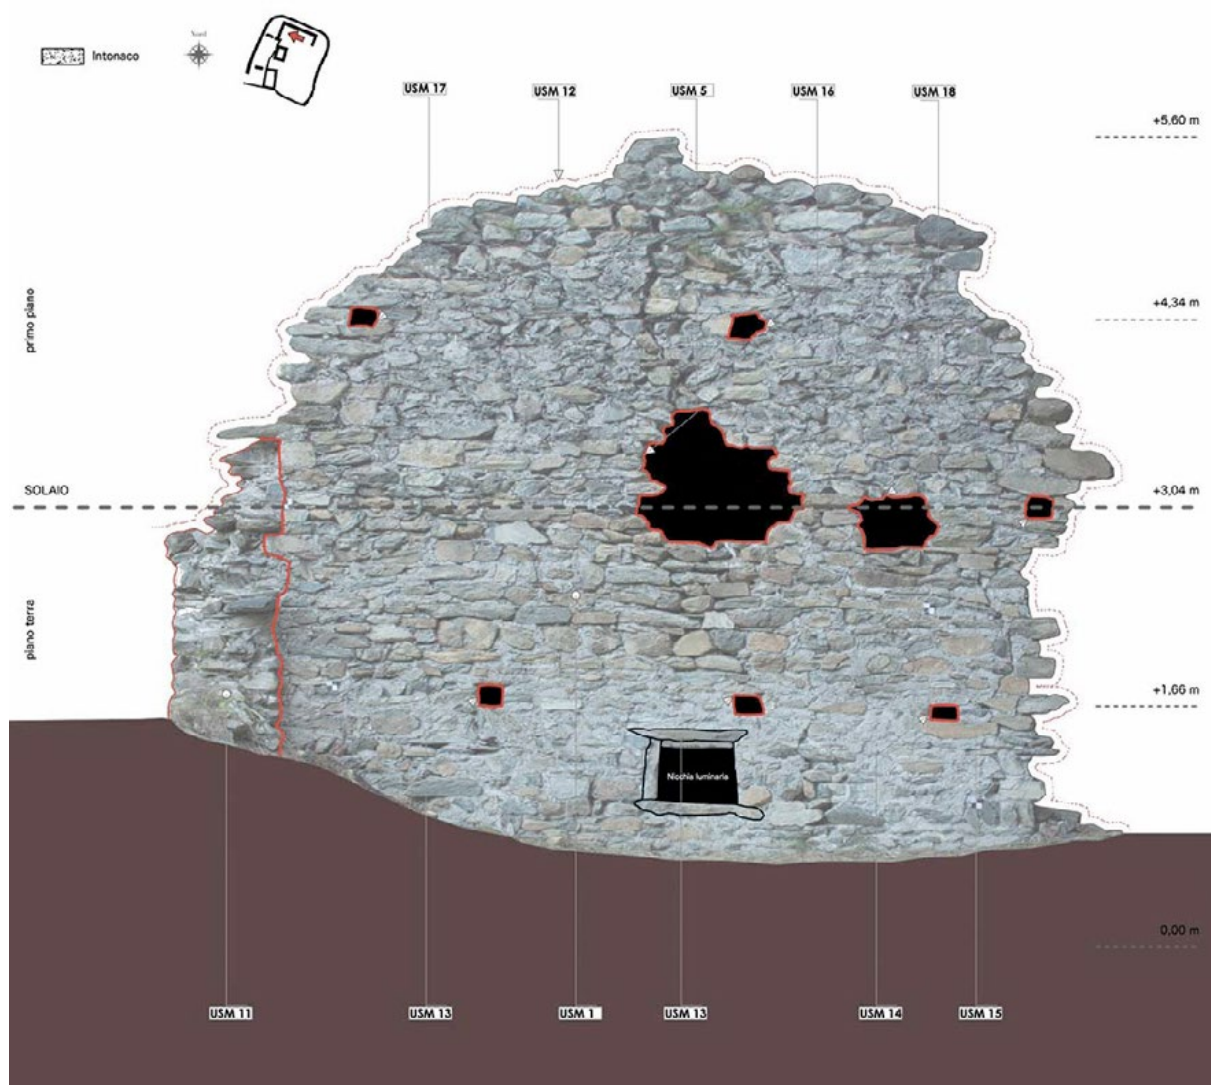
Palazzo del castello, prospetto interno ovest. Rilievo fotogrammetrico e lettura degli alzati.
